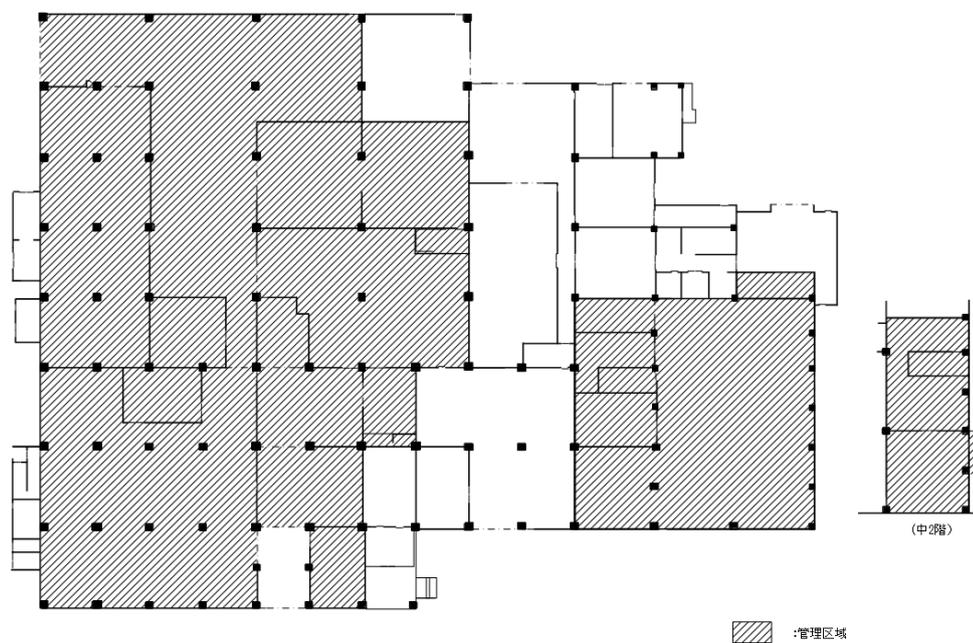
1 製錬転換施設（1階及び中2階）平面図
